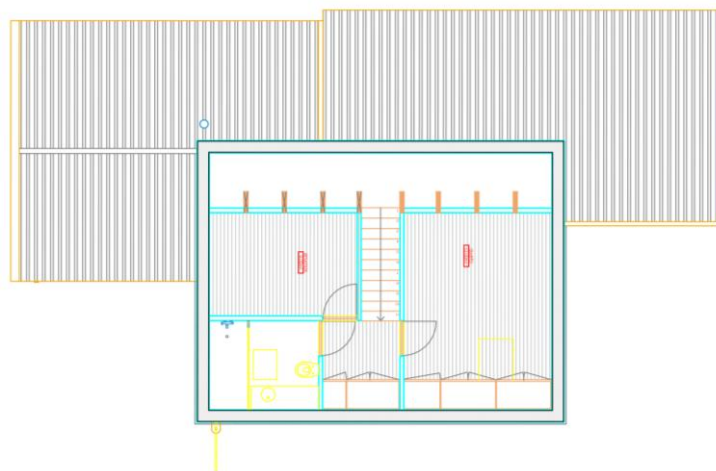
| Planta Piso 1, Garafim, Casa da Antiga Escola, Arq. André Rocha, 2020
